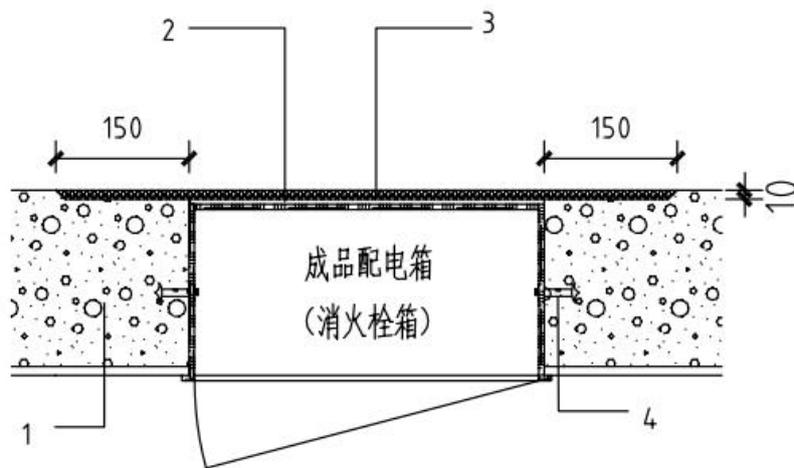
墙体安装箱子墙体示意（暗装）
